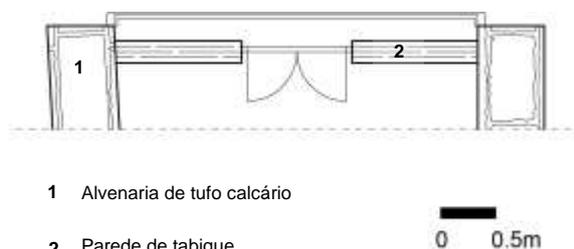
Pormenor, em planta-corte, de exemplo de «sobradinho». (Ilustração nossa, 2021)
